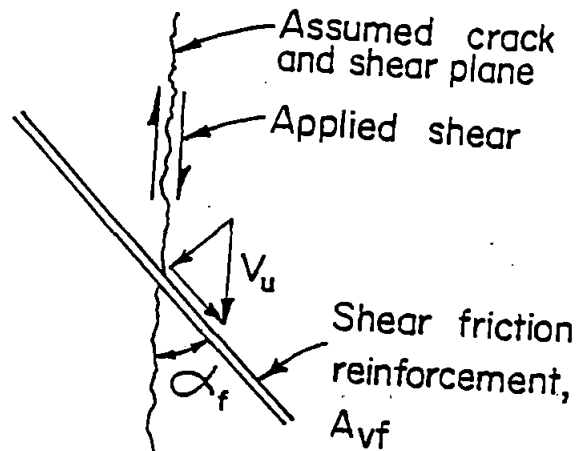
Armadura de corte por fricción a cierto ángulo de la grieta supuesta.
